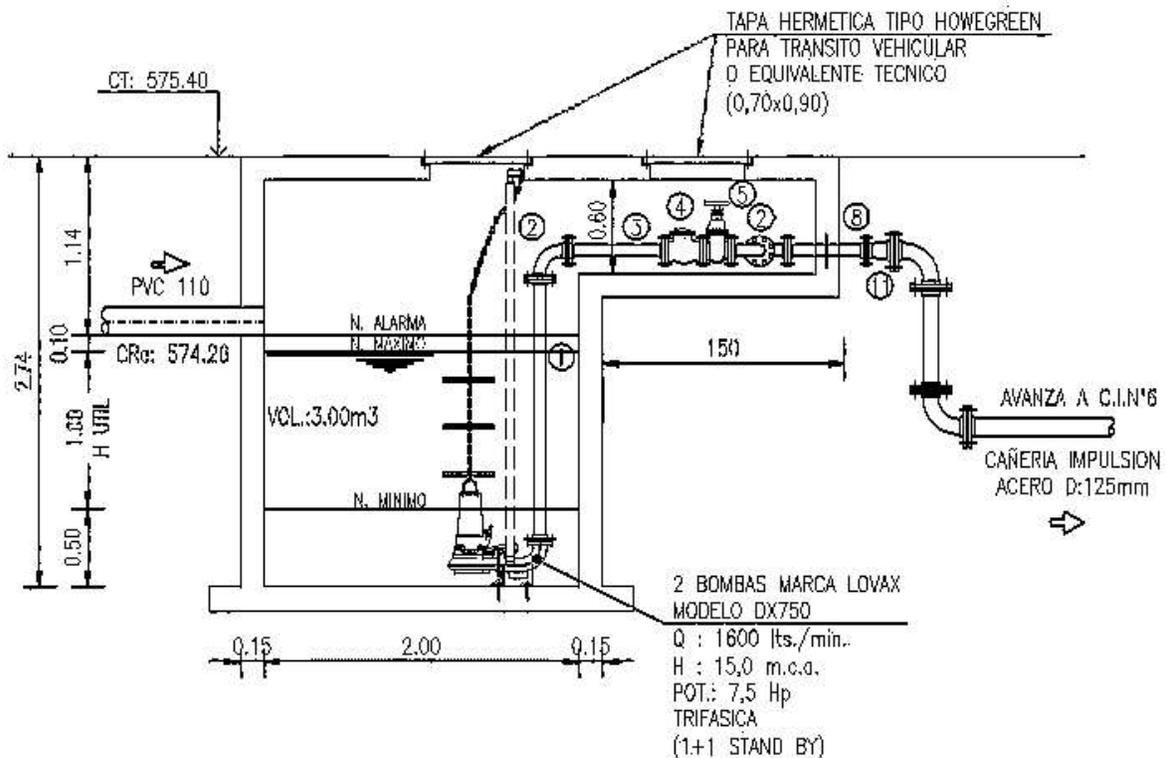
Sistema de Elevación de Agua servidas del CDJGM. Planos del proyecto
